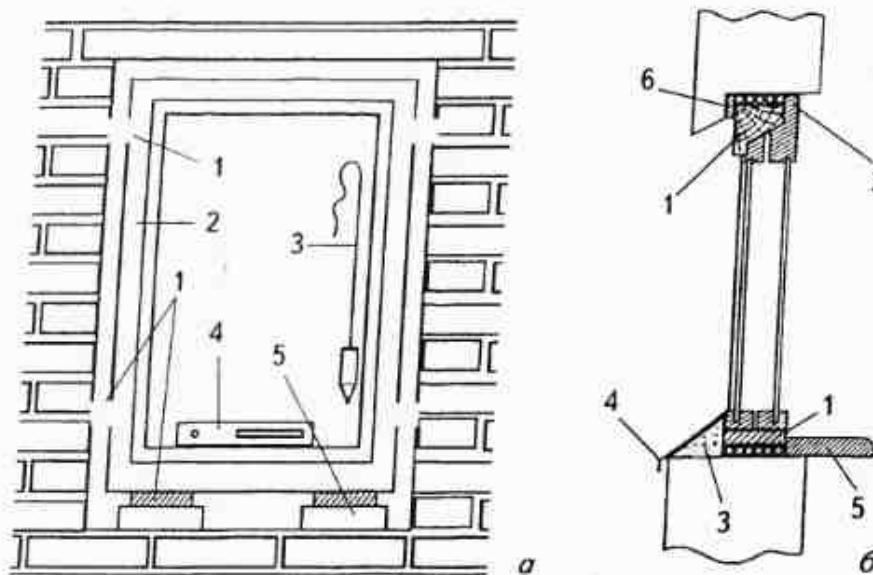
Оконный блок: а — установка: 1 — деревянные клинья; 2 — оконная коробка; 3 — отвес; 4 — уровень; 5 — подкладка из камня или кирпича; б — вид сбоку: 1 — оконная коробка; 2 — теплоизоляция; 3 — отлив; 4 — капельник; 5 — подоконник; 6 — наличник
